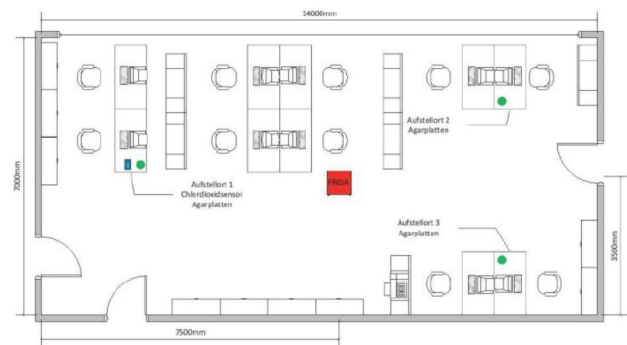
Der Grundriss veranschaulicht die Raumgröße und -ausstattung sowie den Versuchsaufbau
